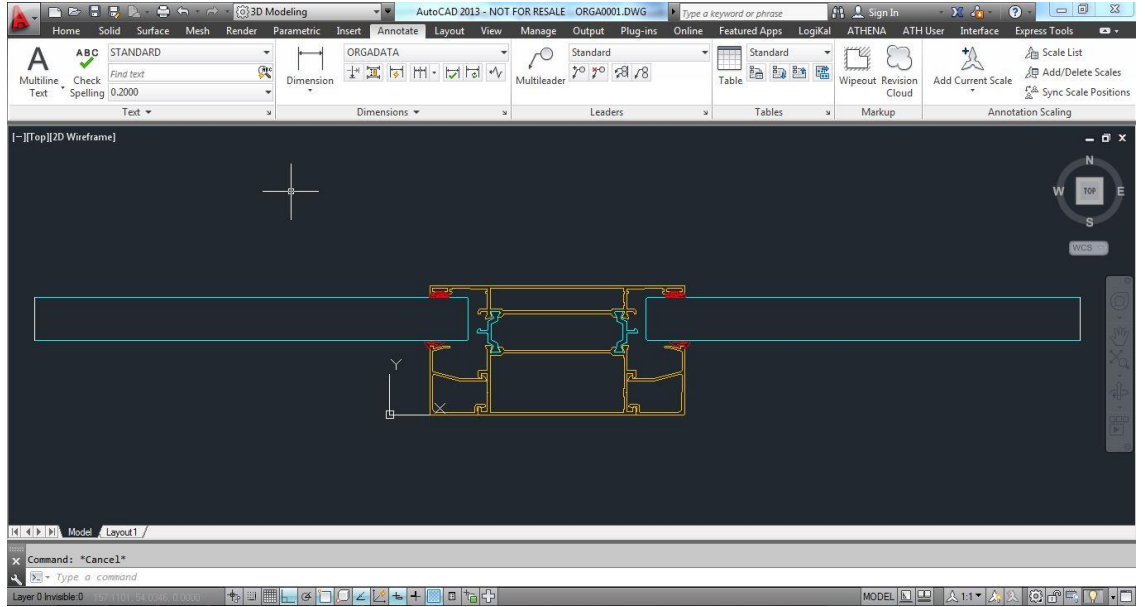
Sistemde kullanılan profilin kesit görünüşü
